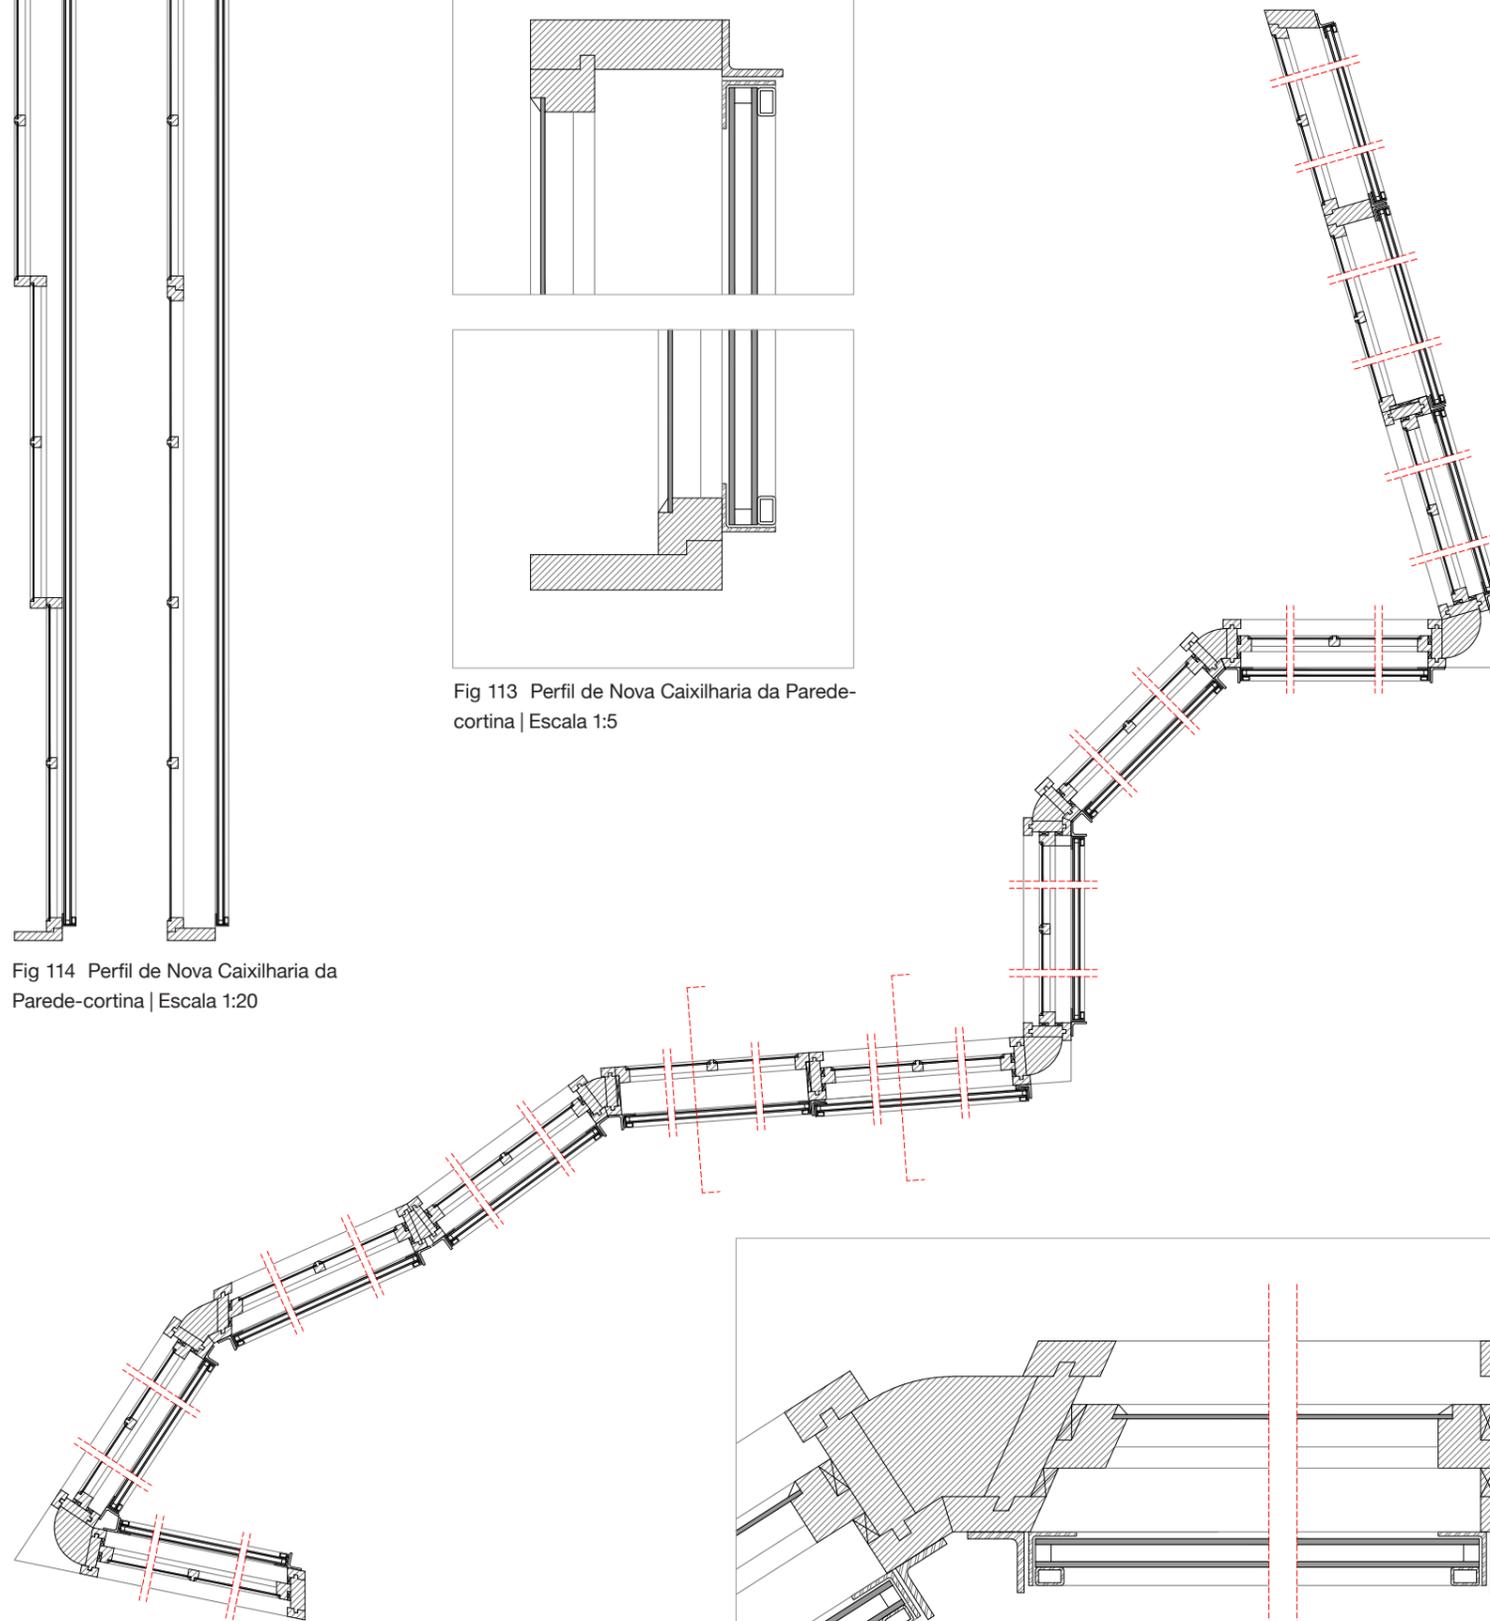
Planta de Nova Caixilharia da Parede-cortina | Escala 1:20
